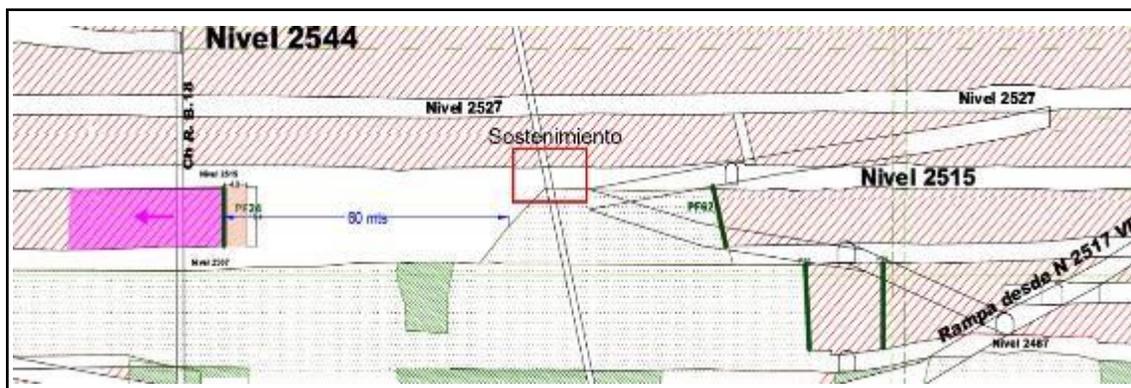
Perfil indicando apertura de cámaras y zona actual a sostener. Fuente: Informe técnico geomecánico. Departamento Geomecánica – YMAD. Año 2020.
